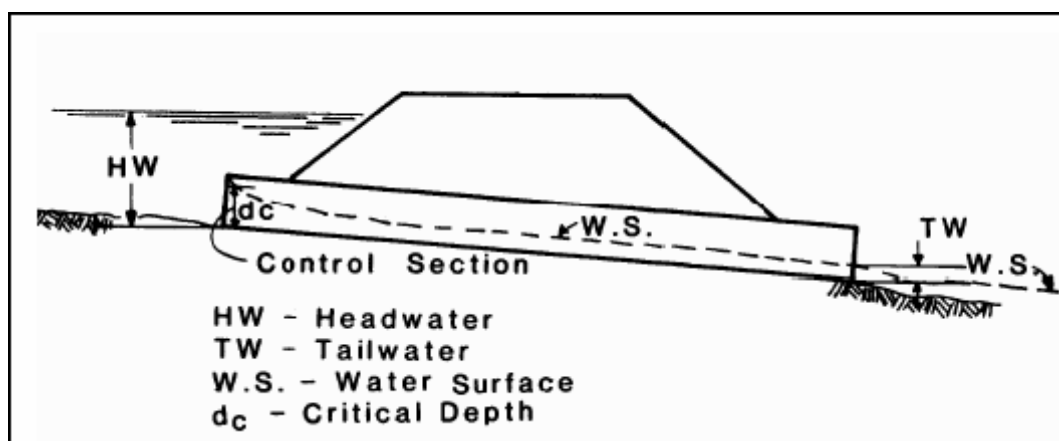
Esempio di moto controllato dalla sezione di ingresso
